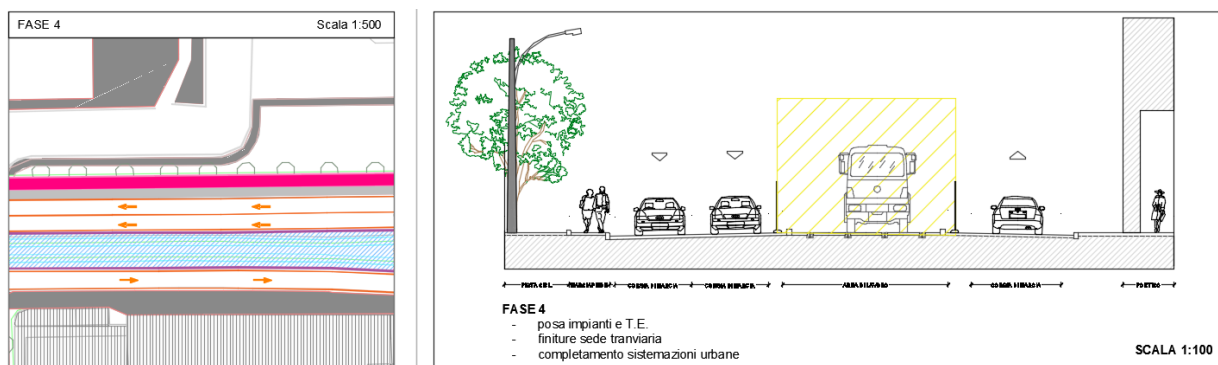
Tipologico cantiere con sede centrale Fase 4
